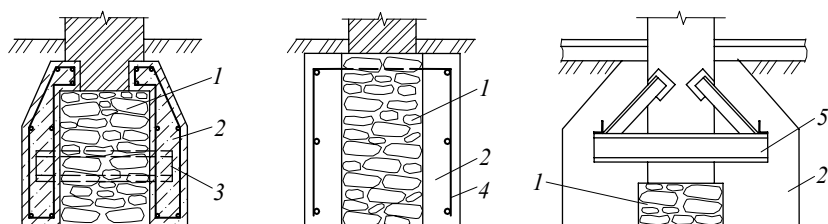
Варианты усиления бутовых и бутобетонных фундаментов:
